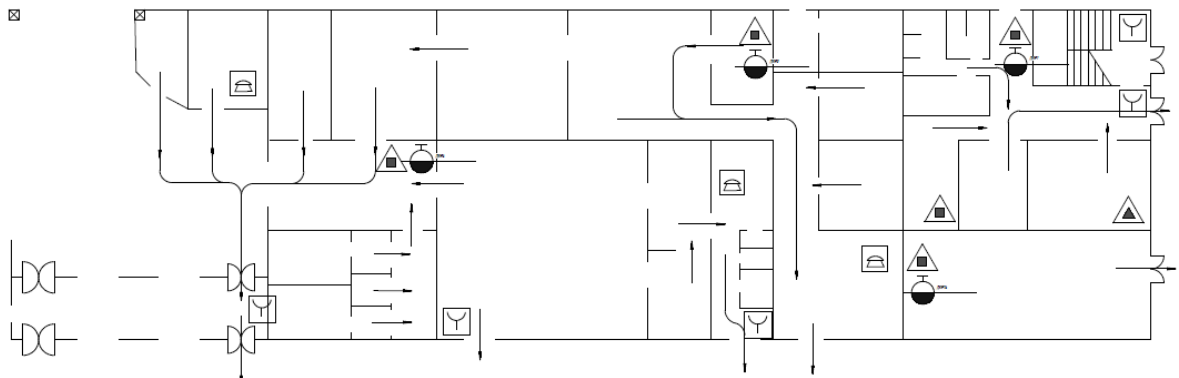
План эвакуации при пожаре, сварочный цех
